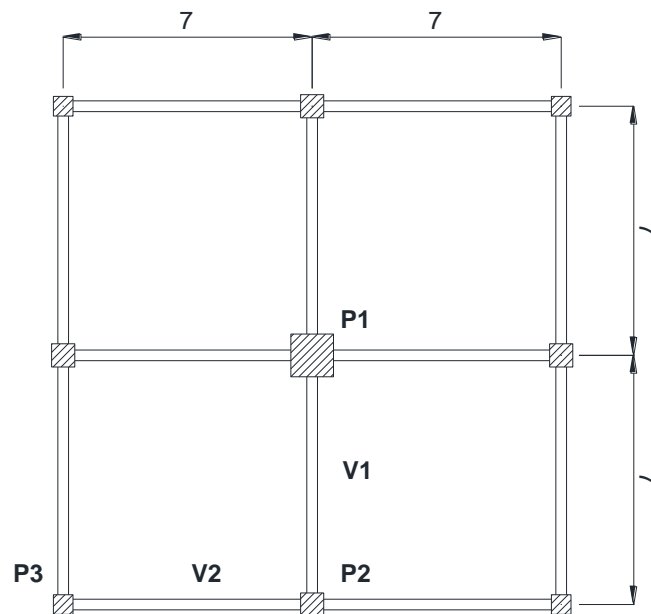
Planta genérica de um piso do caso idealizado (m)
